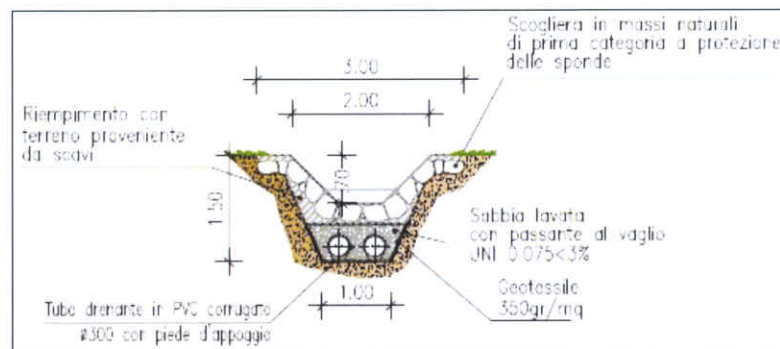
area “Roncaglie”, canale con drenaggio alla base – sezione tipo C.
